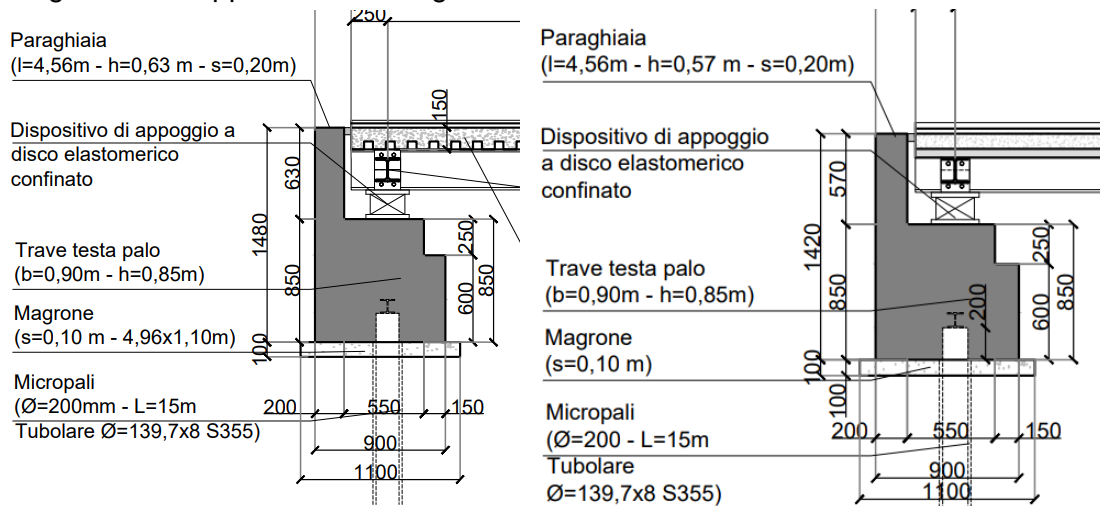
Sezioni Spalle di fondazione: a sx "2B" e DX "1C e 1D"
